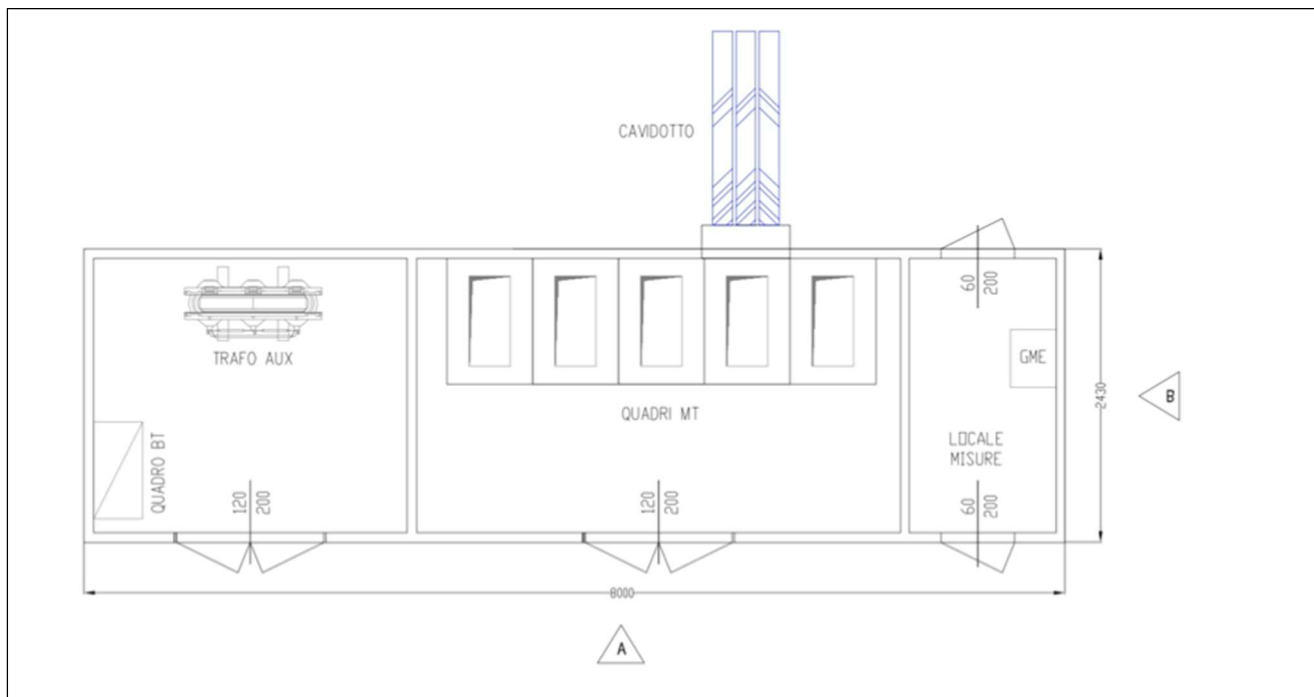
Locale cabina di Parallelo MT-Prospetto
